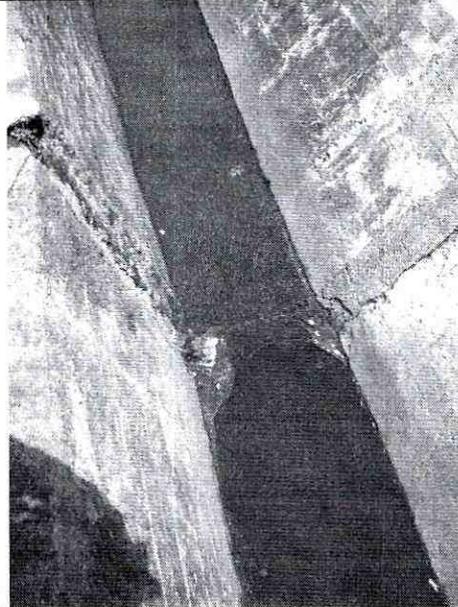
Junta de construcción en la cual se evidenció la filtración de aguas a la ladera.
